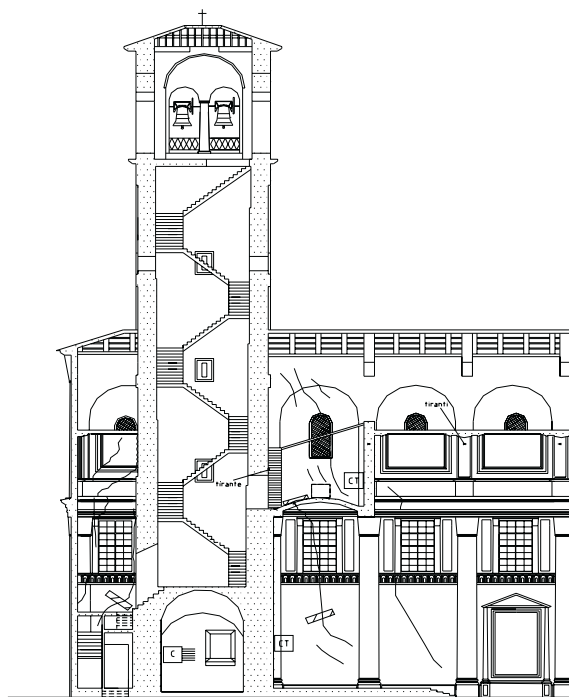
SEZIONE LONGITUDINALE DELLA TORRE CAMPANARIA
